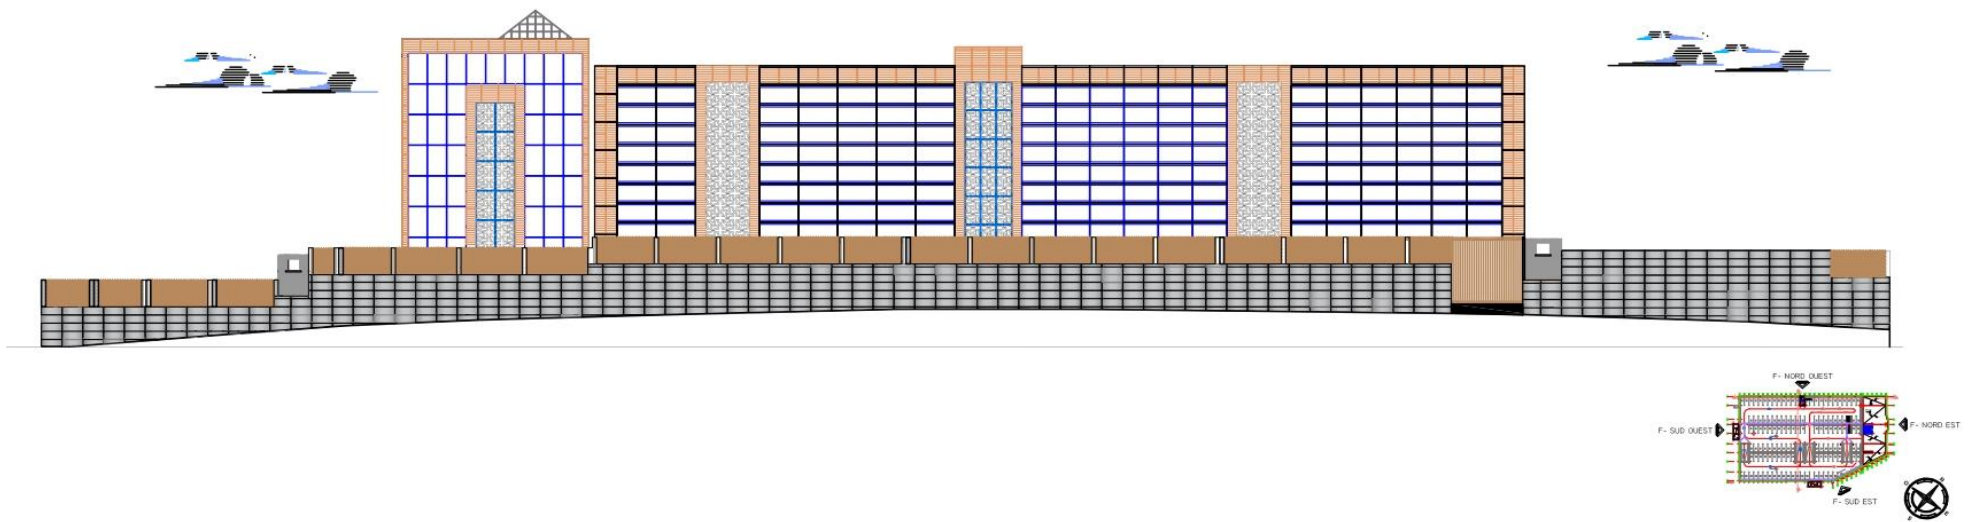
Plan d'architecture de la façade Nord-Ouest [Autodesk AutoCAD 2023]
